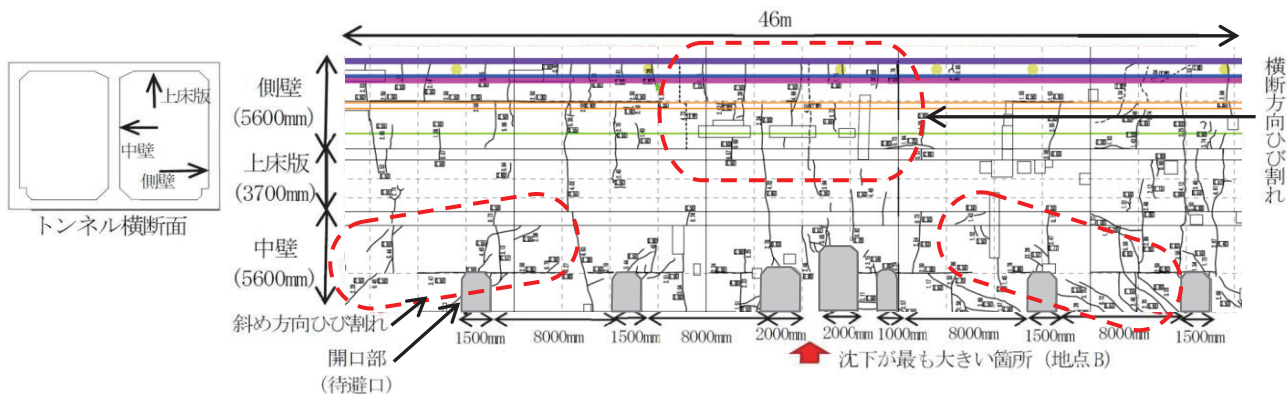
地点 B 付近のトンネル内のひび割れ状況
